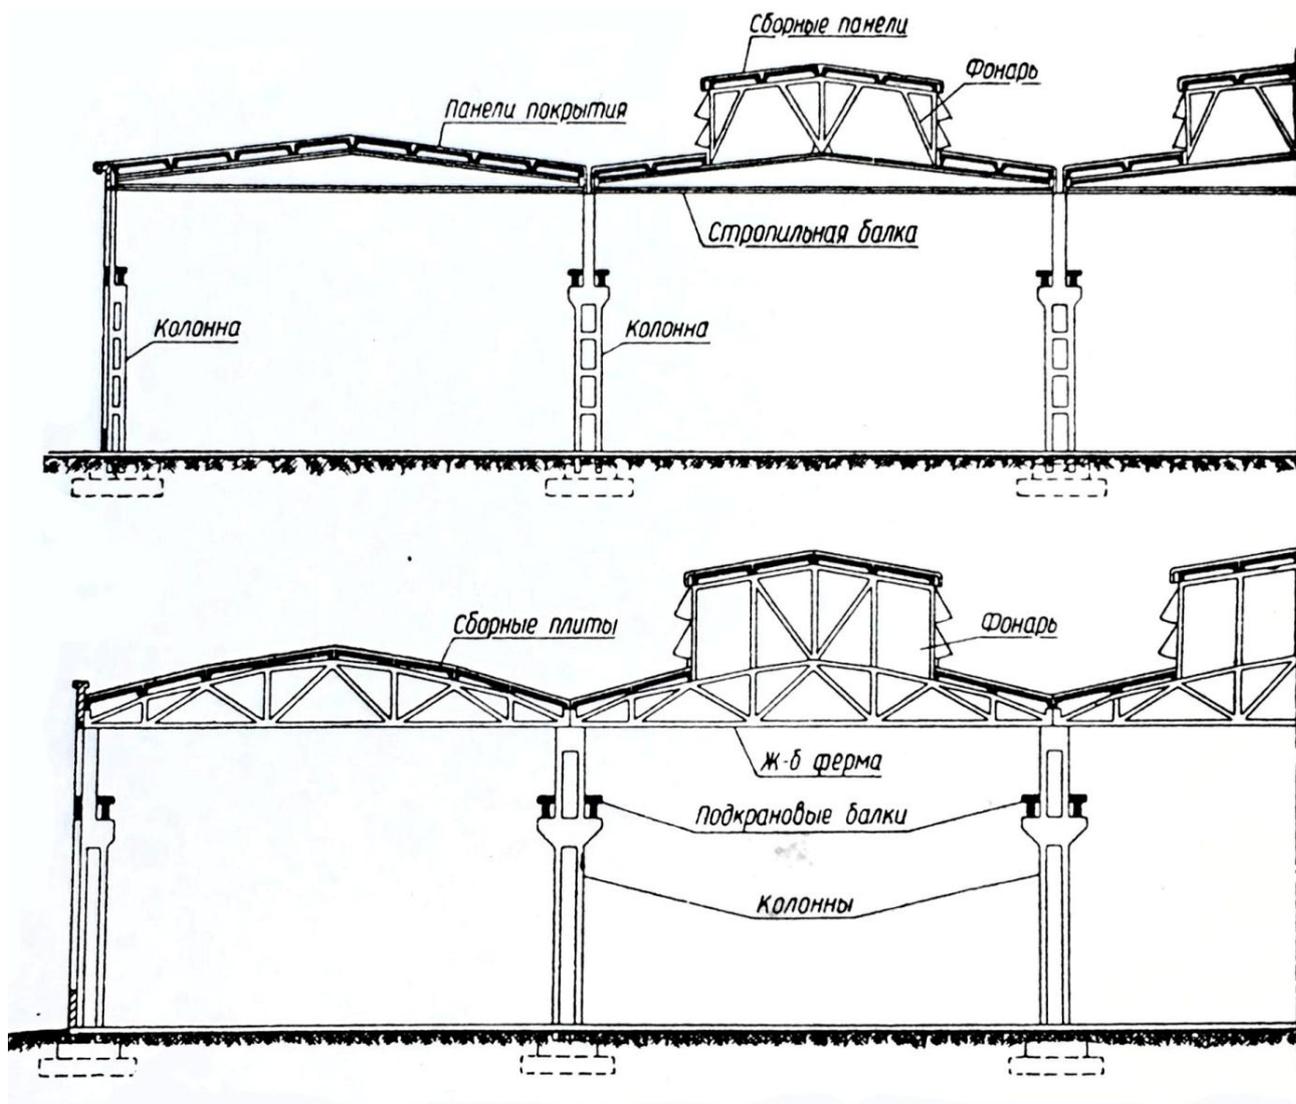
Сборные железобетонные конструкции одноэтажных промышленных зданий: сверху - с покрытием по стропильным балкам; внизу - с покрытием по стропильным фермам
